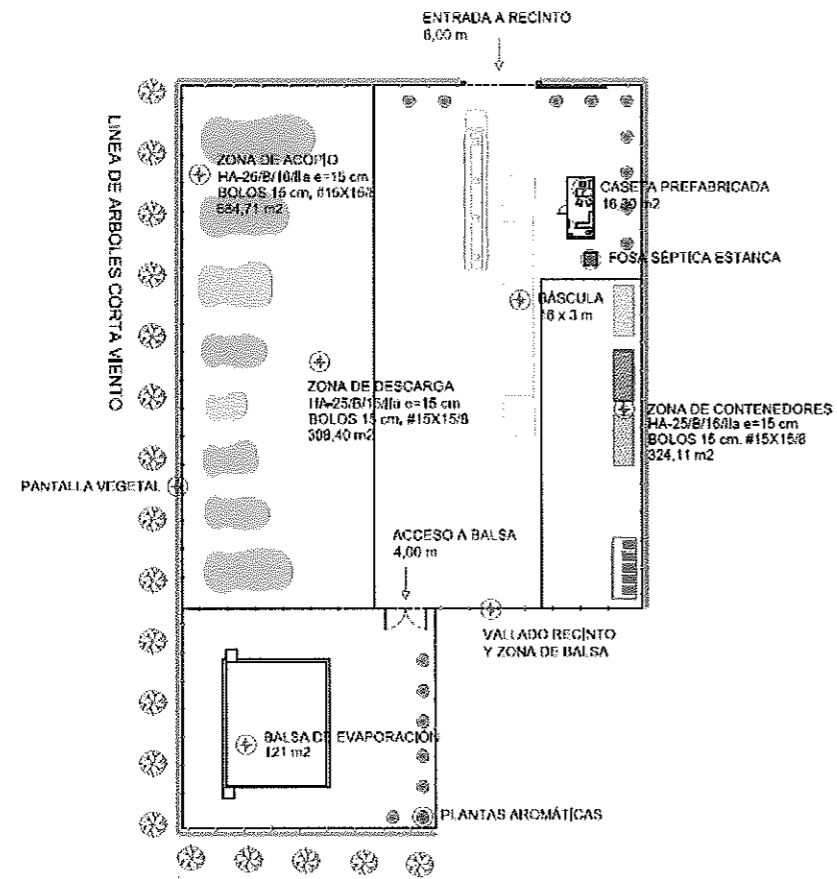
Planta de RCD's planteada. Fuente: elaboración propia.
